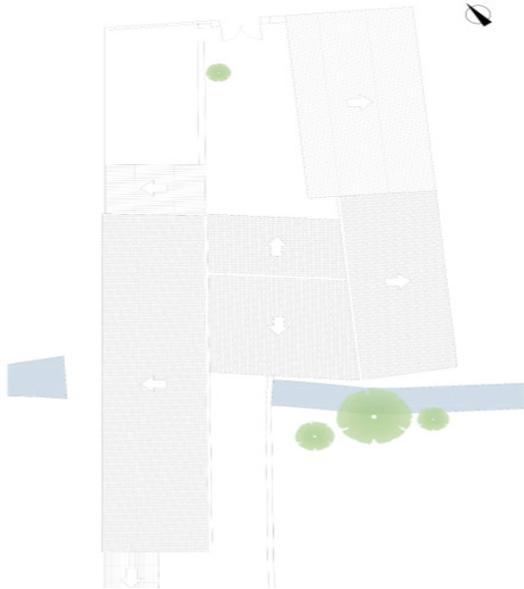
Vistas de las imágenes. Planta Baja. Autor Propio. 2015
